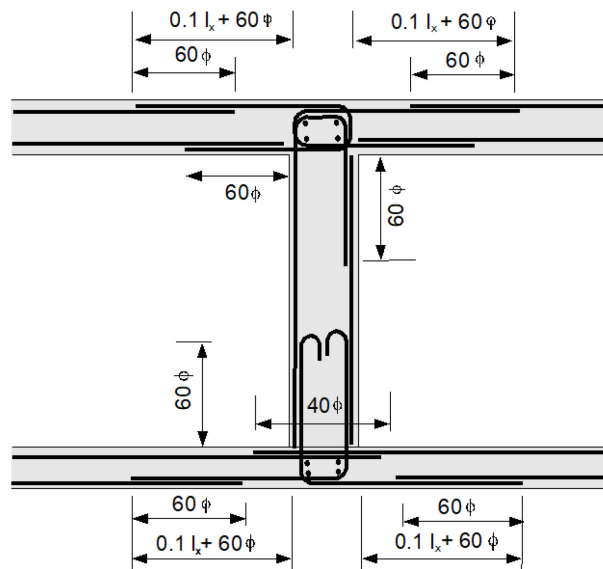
Bewehrung bei einer Wand zwischen zwei Schutzbauten (nur Biegebewehrung dargestellt)
